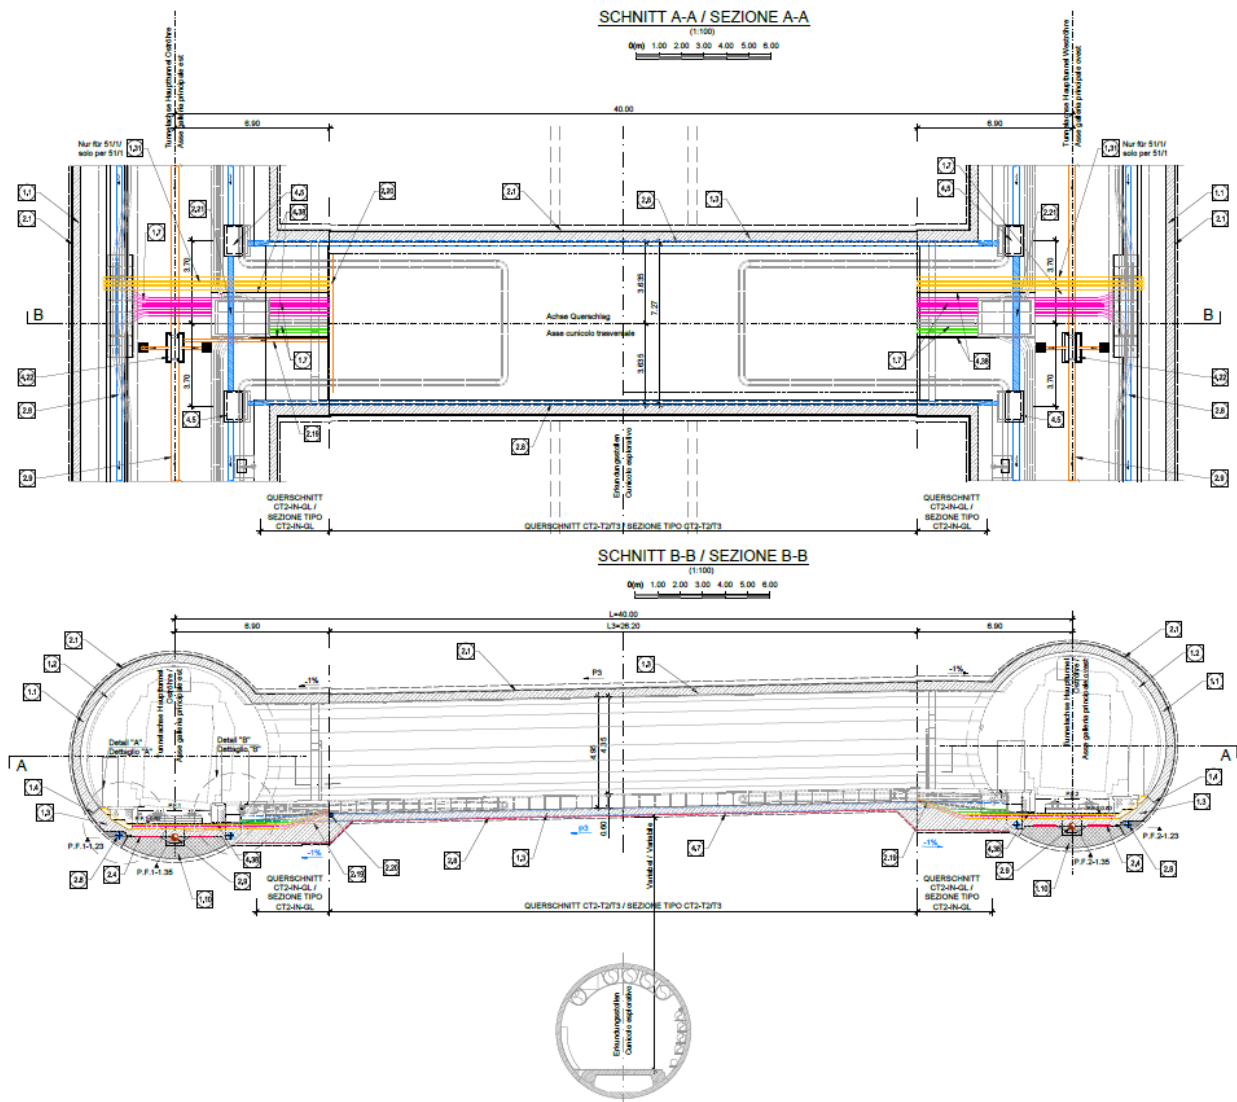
Querstollen Typ 2 - Grundriss und Längsschnitt [30].
